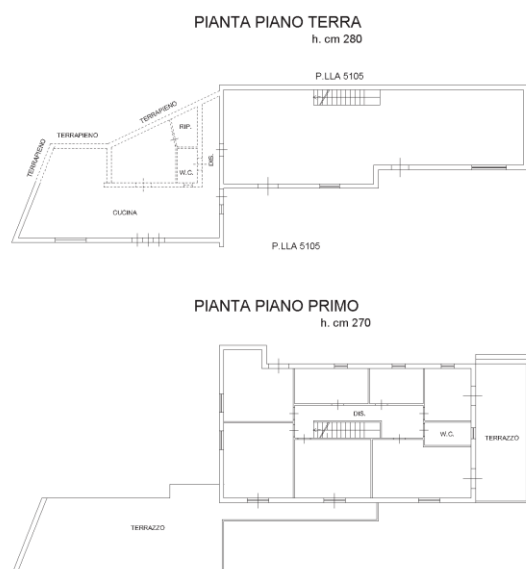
planimetria catastale del piano terra e del primo piano della villa – sub 3
